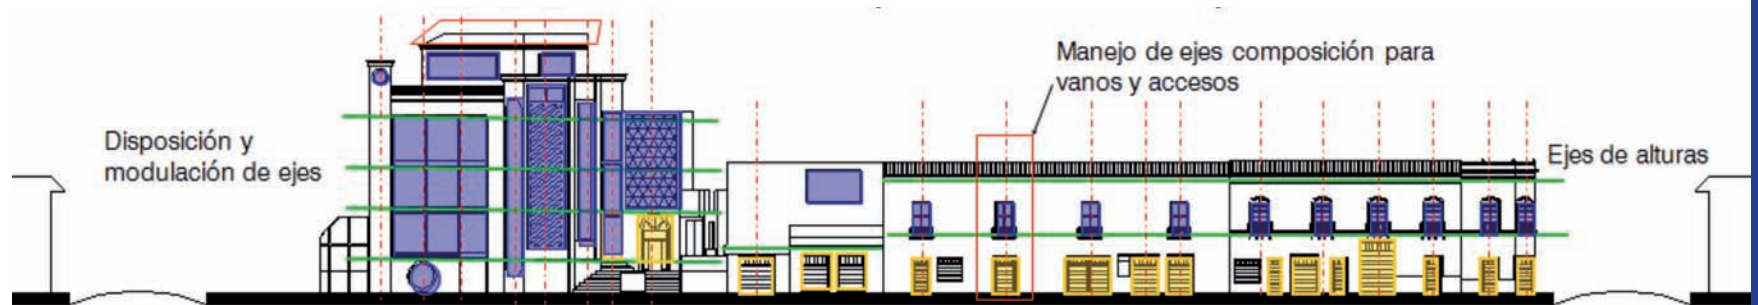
//Levantamiento de fachada, Calle 19 entre carreras 23 y 22 - área de estudio//
